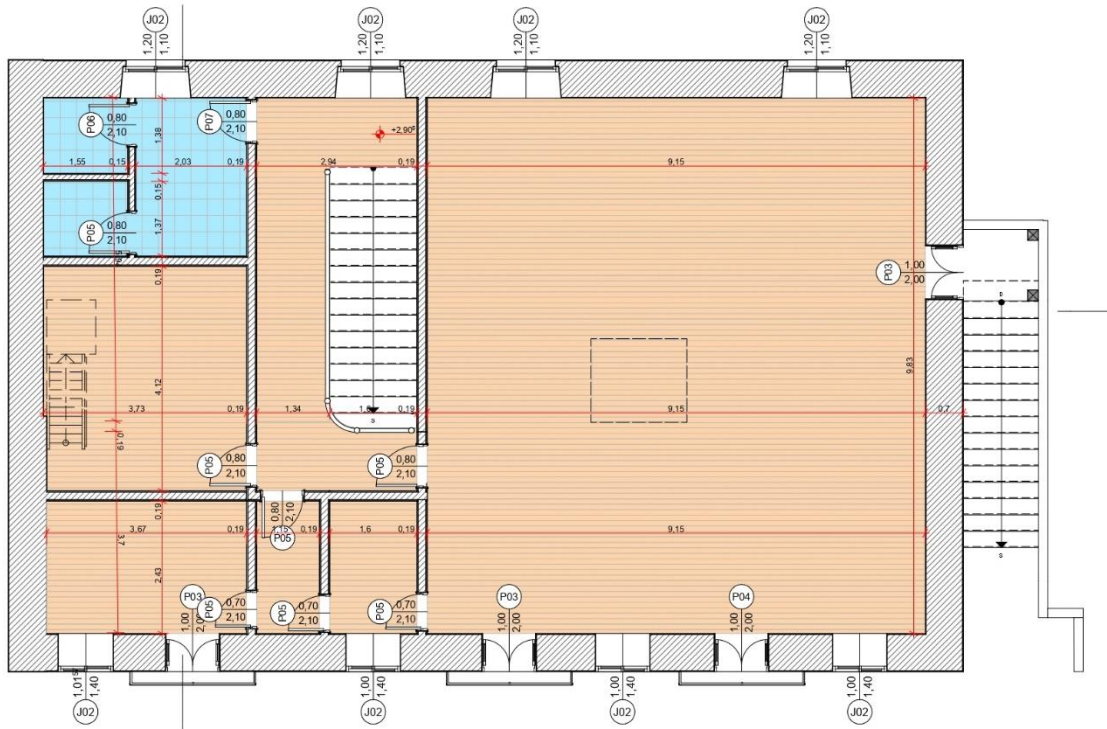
Planta do primeiro andar (acervo do autor 2024)
